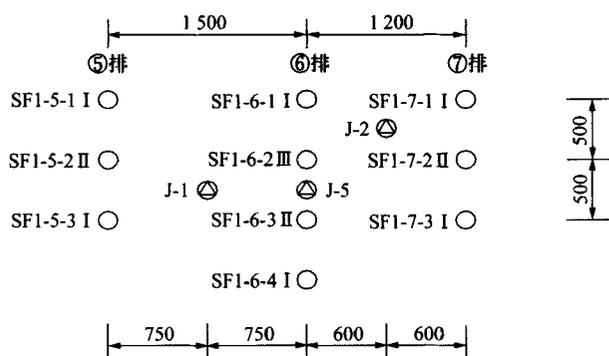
灌浆试验区井壁孔位平面布置示意(单位: mm)
